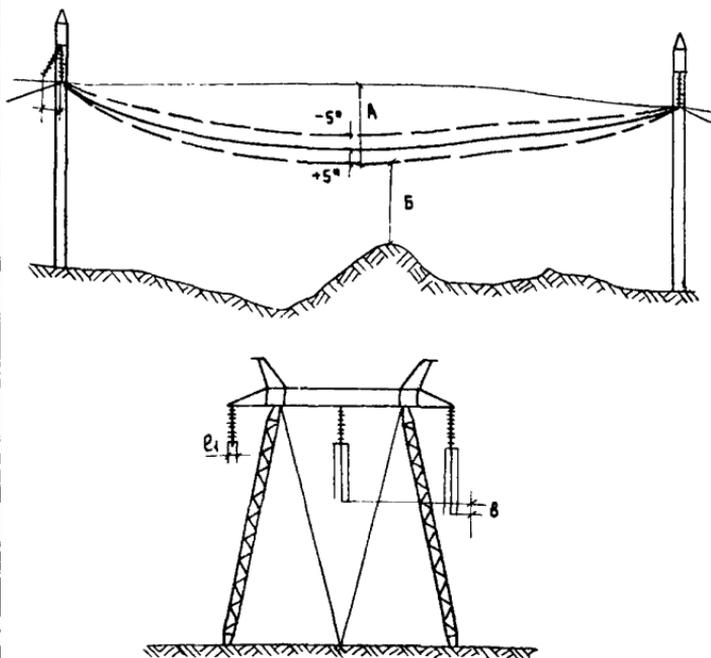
Нормы и допуски на монтаж проводов
